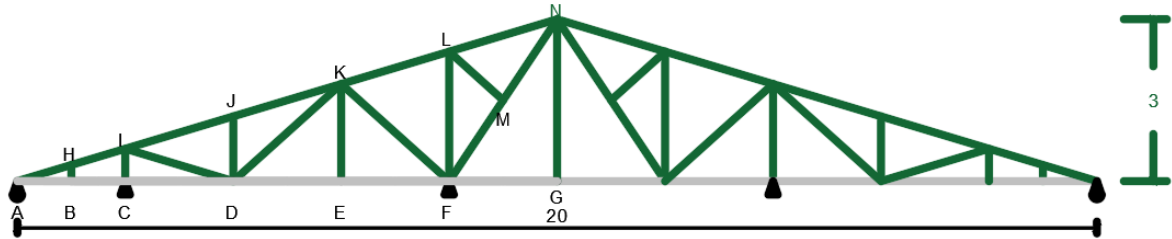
Sección 3 de análisis bajo cargas de nieve. Fuente: Elaboración Propia
